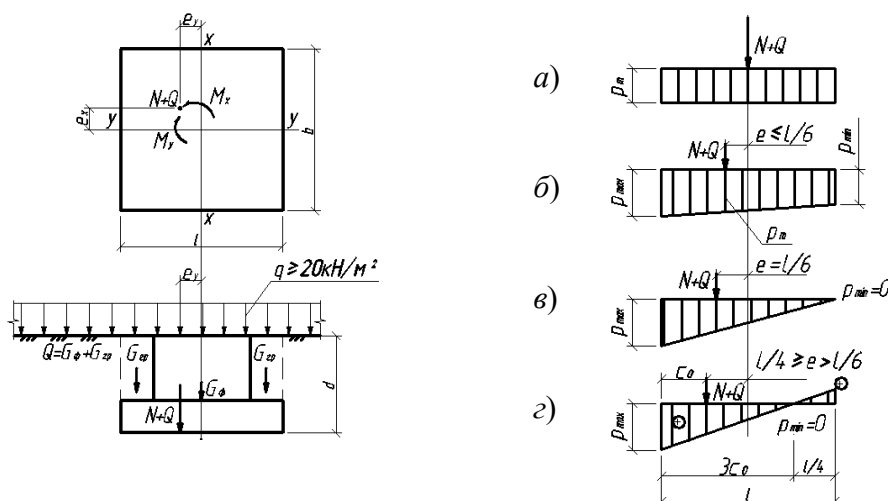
Схема действия сил на фундамент и эпюры контактных давлений на грунт в уровне подошвы фундамента при центральной и внецентренной нагрузках
